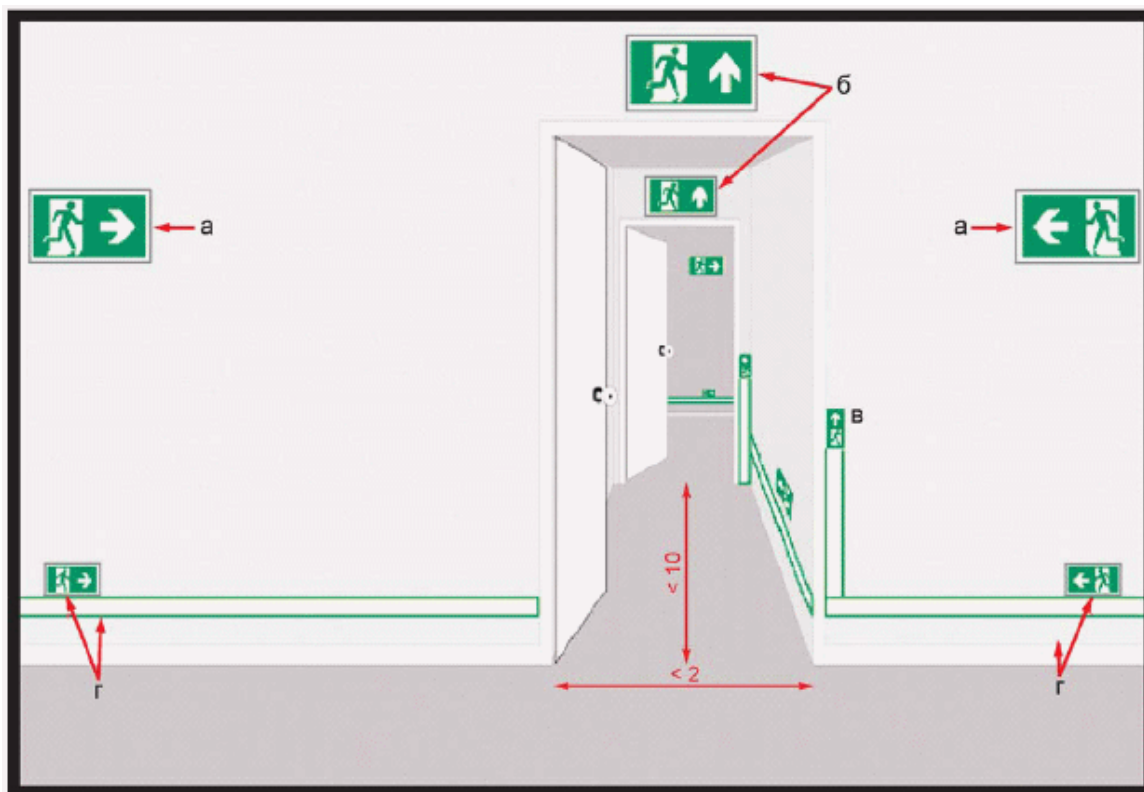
Примерный план Т-образного перекрестка, ведущего в прямой коридор (с более чем одной дверью), показывающий непрерывность обозначения
